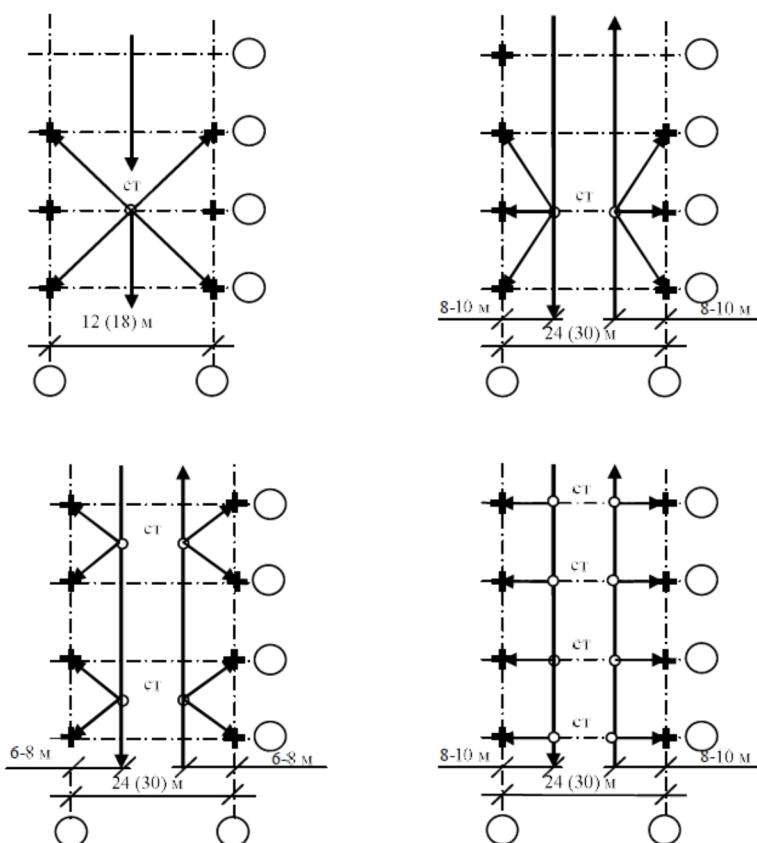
Схемы расположения стоянок крана при монтаже колонн
